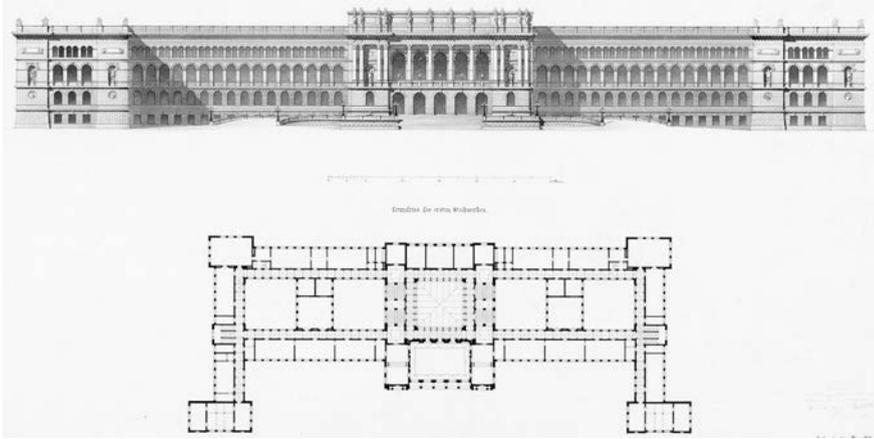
Königliche Technische Hochschule Charlottenburg (später TU Berlin), erbaut 1879-1884, Frontalansicht des Hauptgebäudes u. Grundriss, Architekt: Friedrich Hitzig, Druck: 1884
